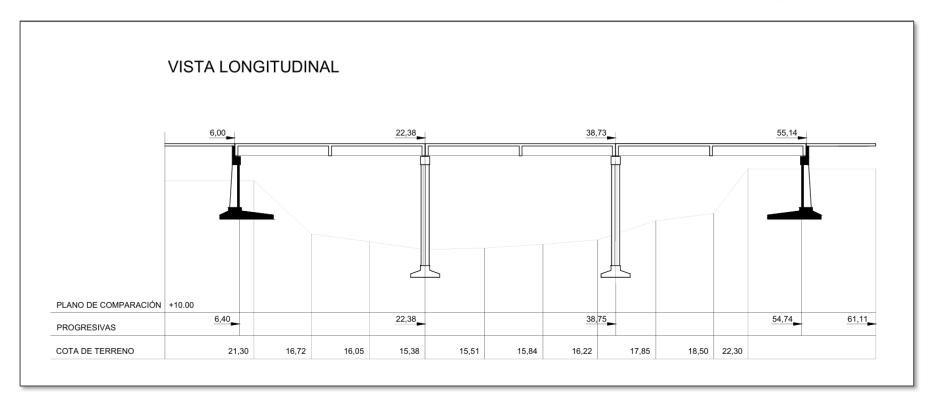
Vista longitudinal del puente del Arroyo Tapalqué sobre Av. de los Trabajadores.
